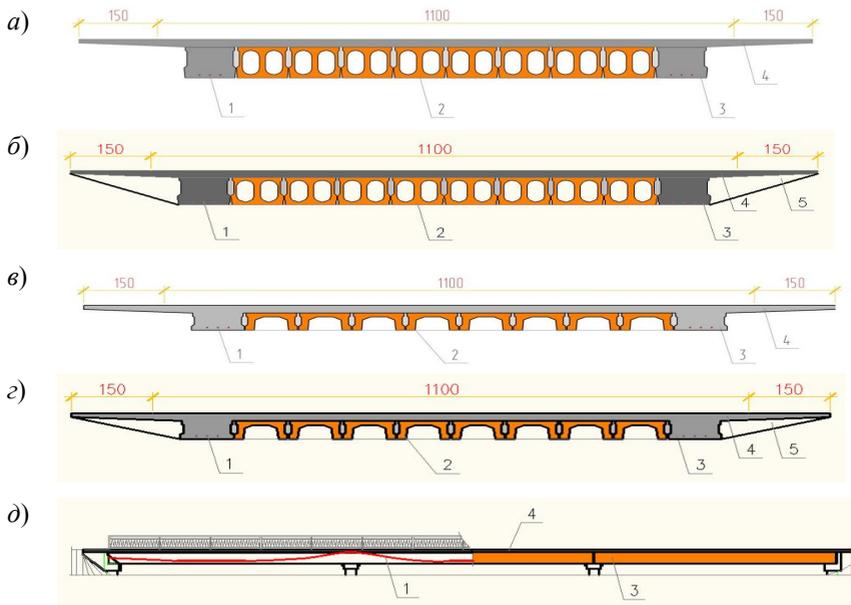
Схемы уширения плитных пролетных строений монолитной накладной плитой с установкой крайних монолитных балок с напрягаемой арматурой без изменения конструкции опор :
